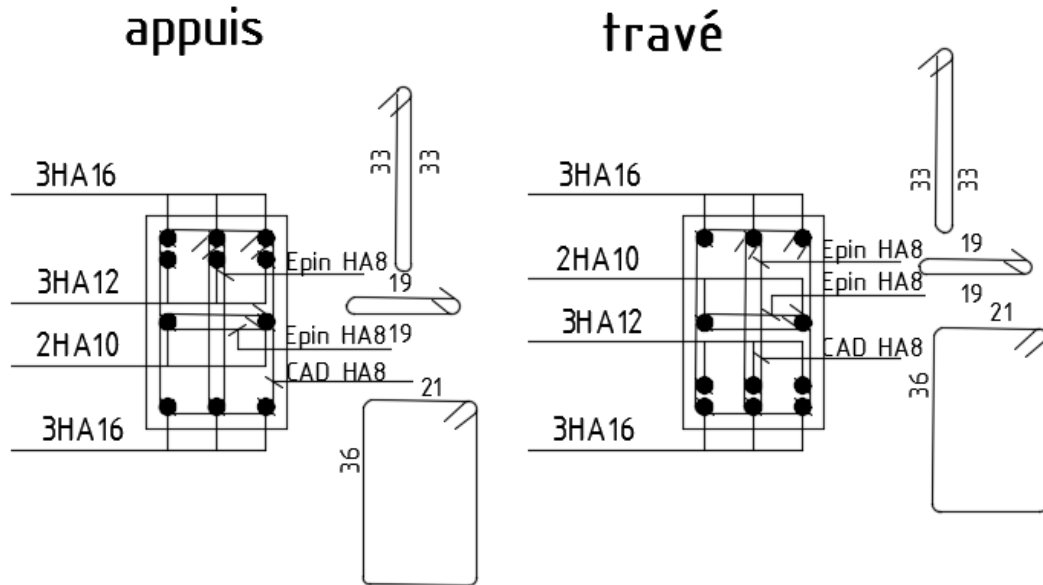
Ferraillage de la poutre principale (30x45)
